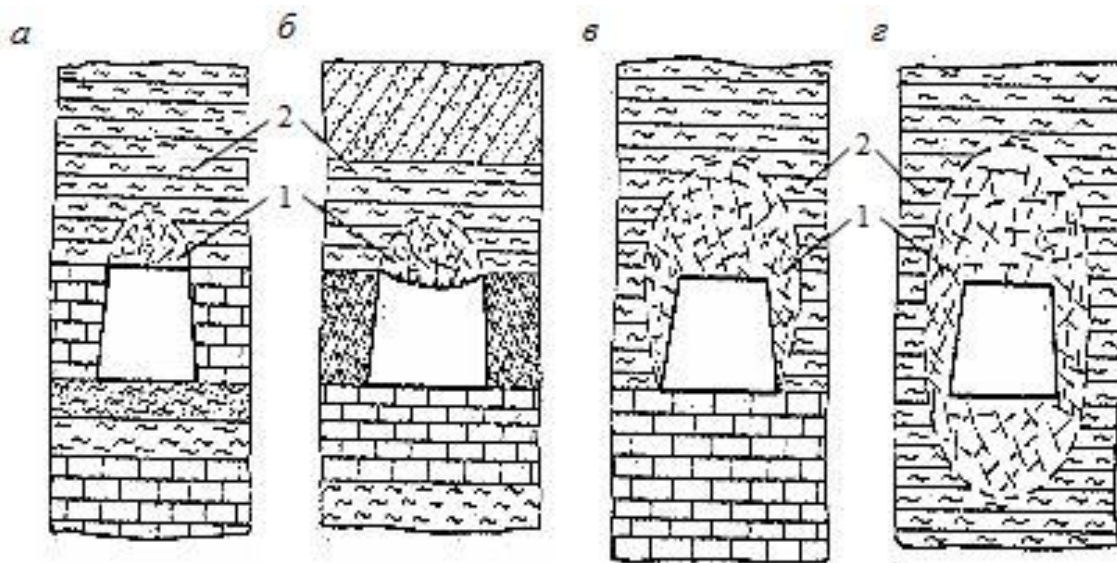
Возможные контуры разрушения пород вокруг горизонтальной выработки: а,б – в кровле; в – в кровле и с боков; г – в кровле, с боков и в почве.
